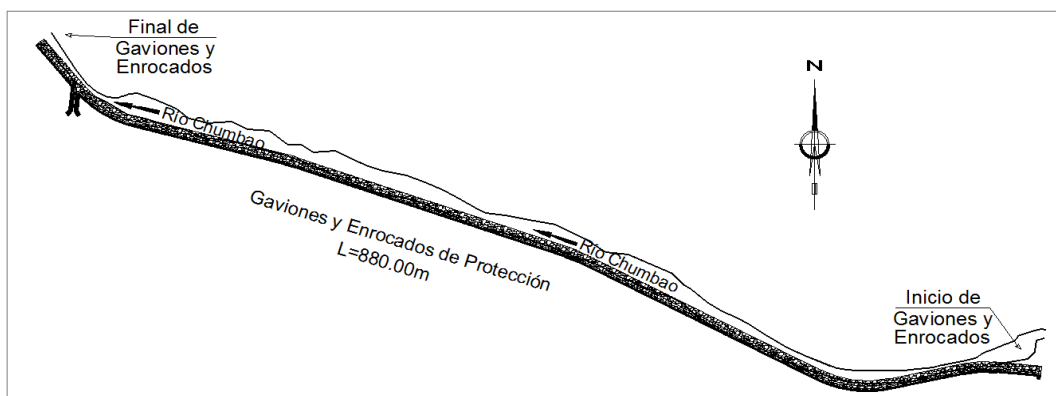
Vista en planta de la ubicación de los gaviones y enrocado de protección sobre el río Chumbao.
